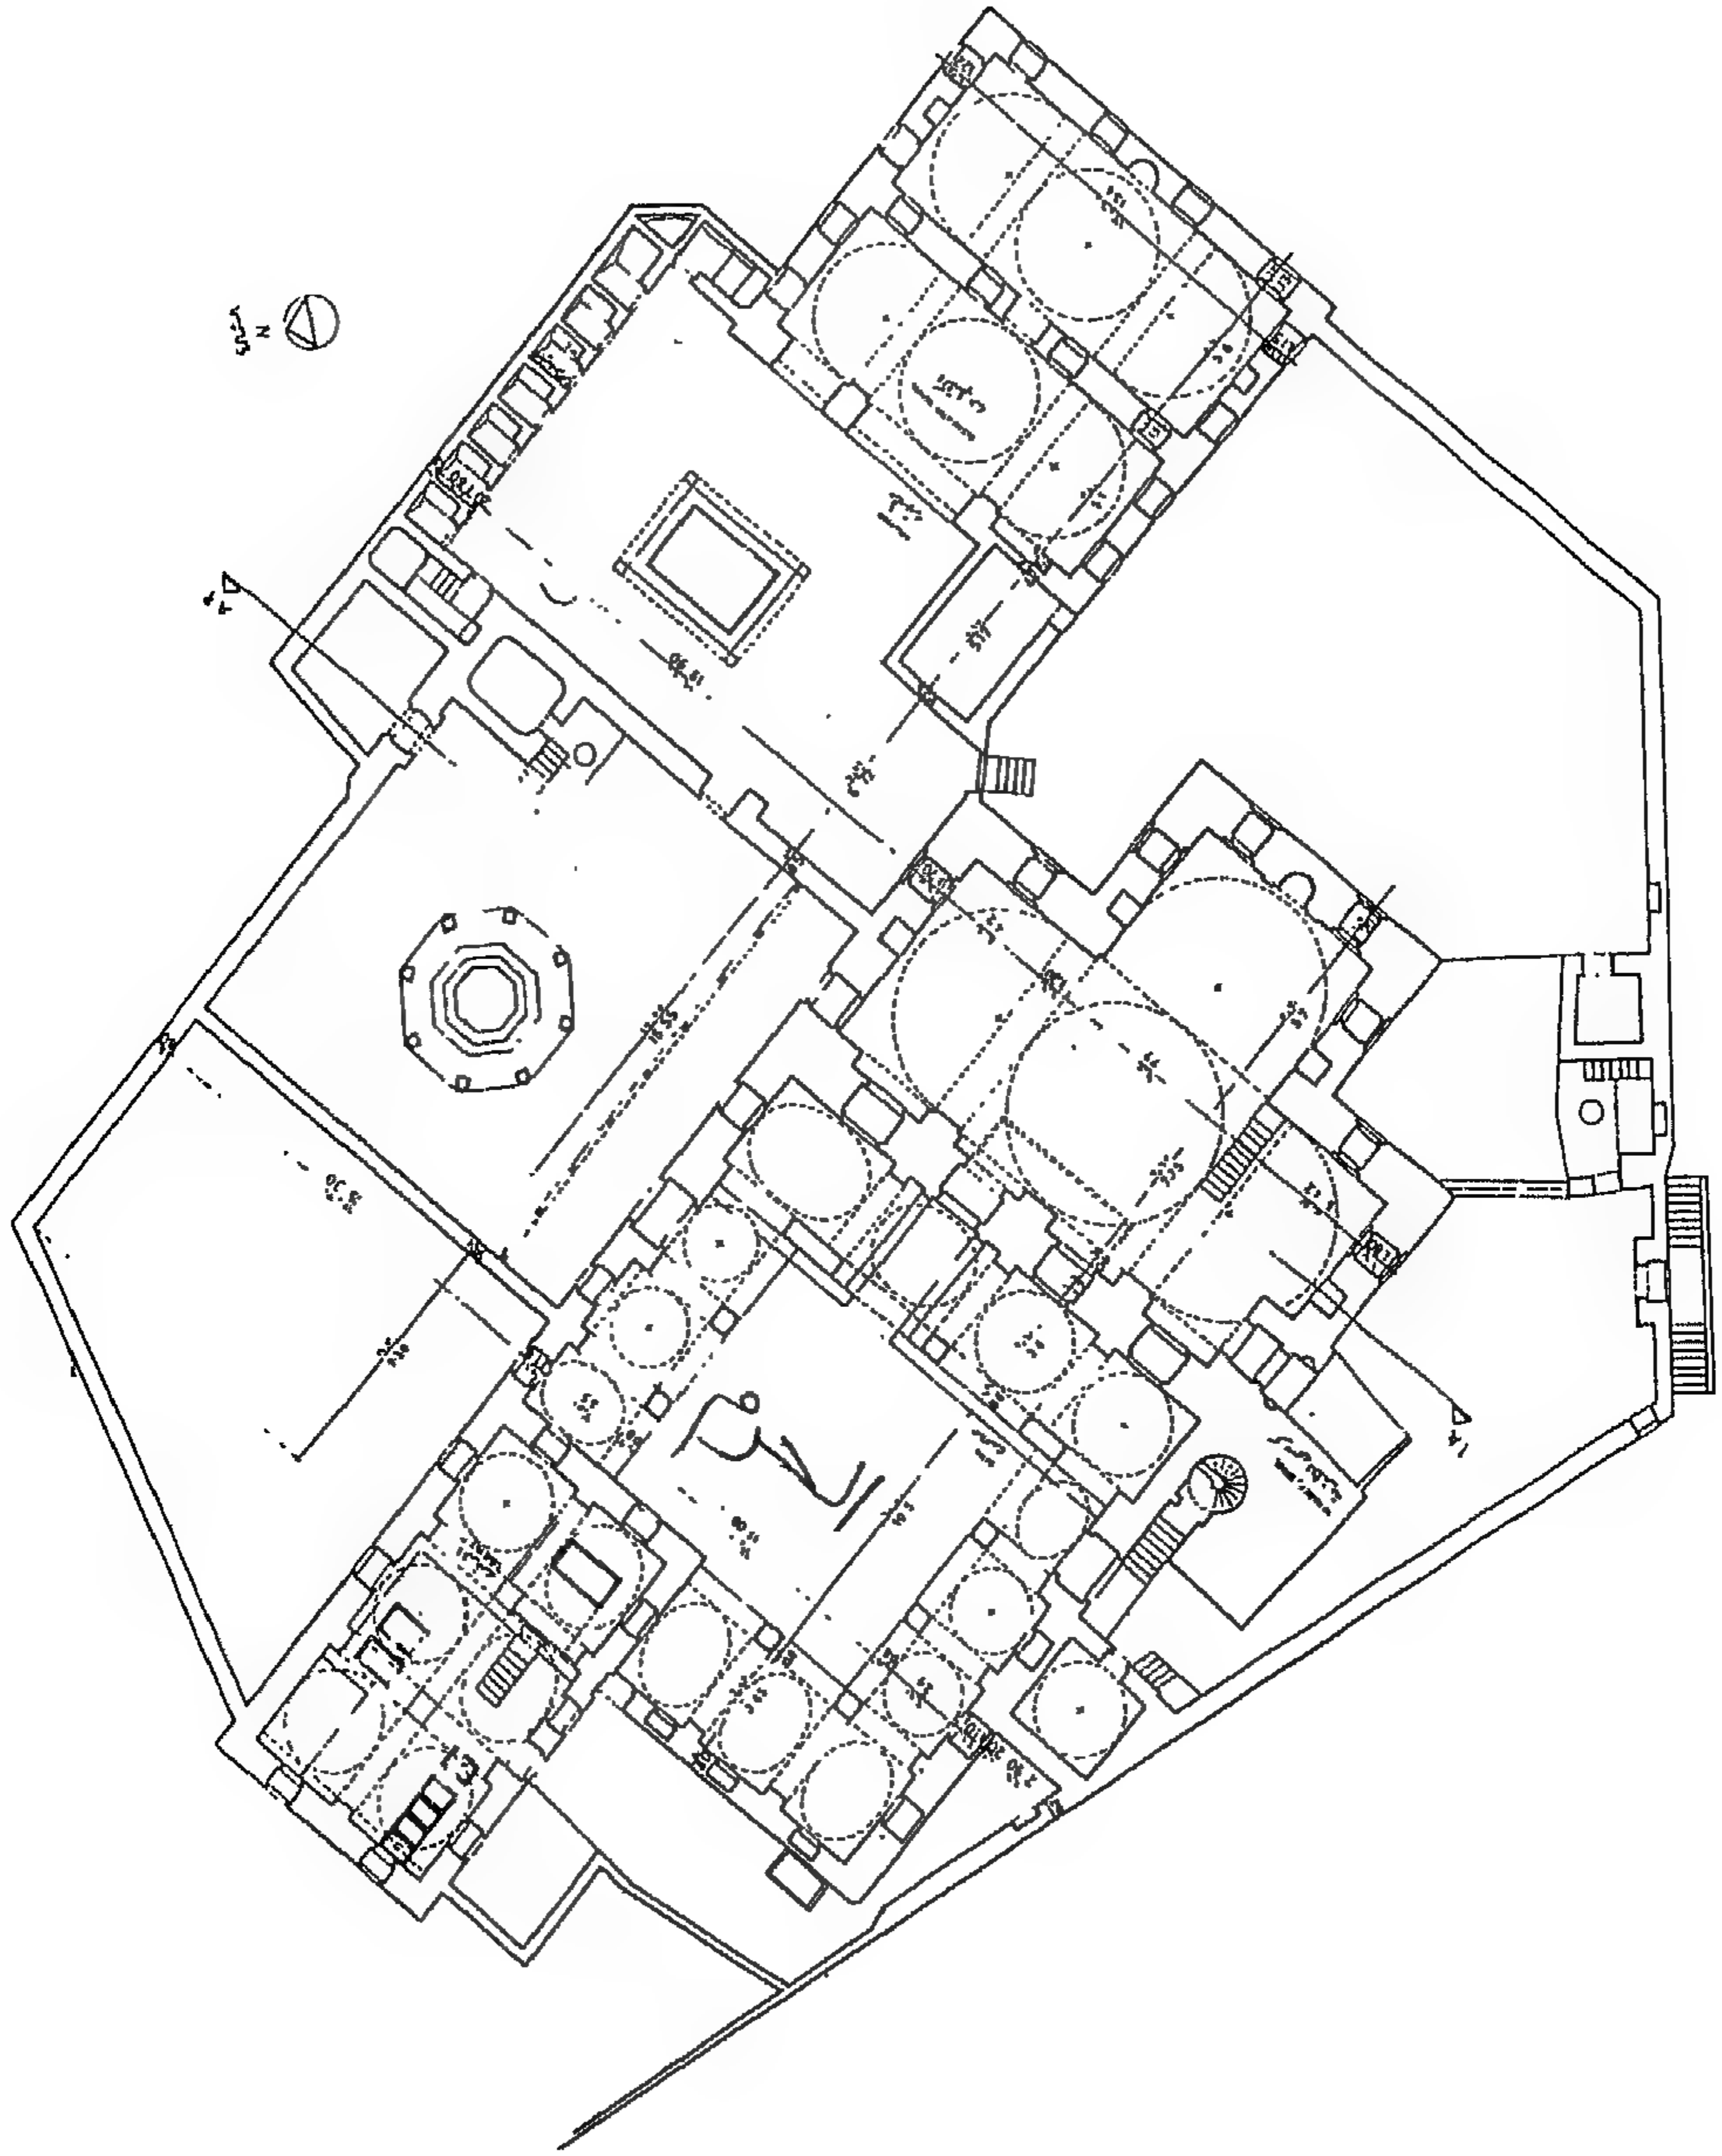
مكرر) مسقط أفقي لخانقاة السلطان برسباي ضمن مجمعه
